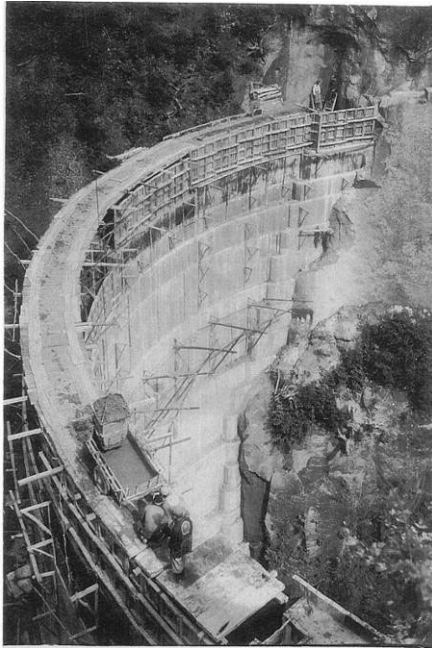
施工中の真船堰堤（1954（昭和29）年頃）
